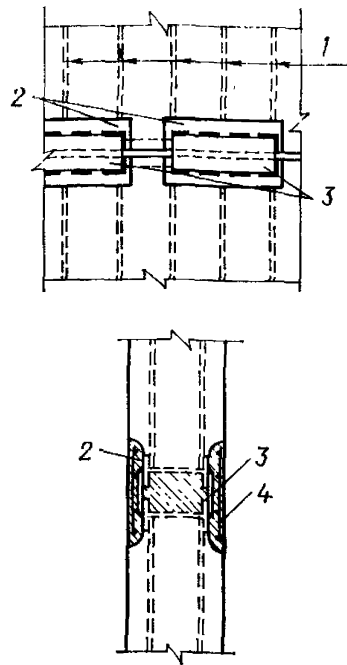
Армирование наклонных ребер воронки угловыми стержнями
